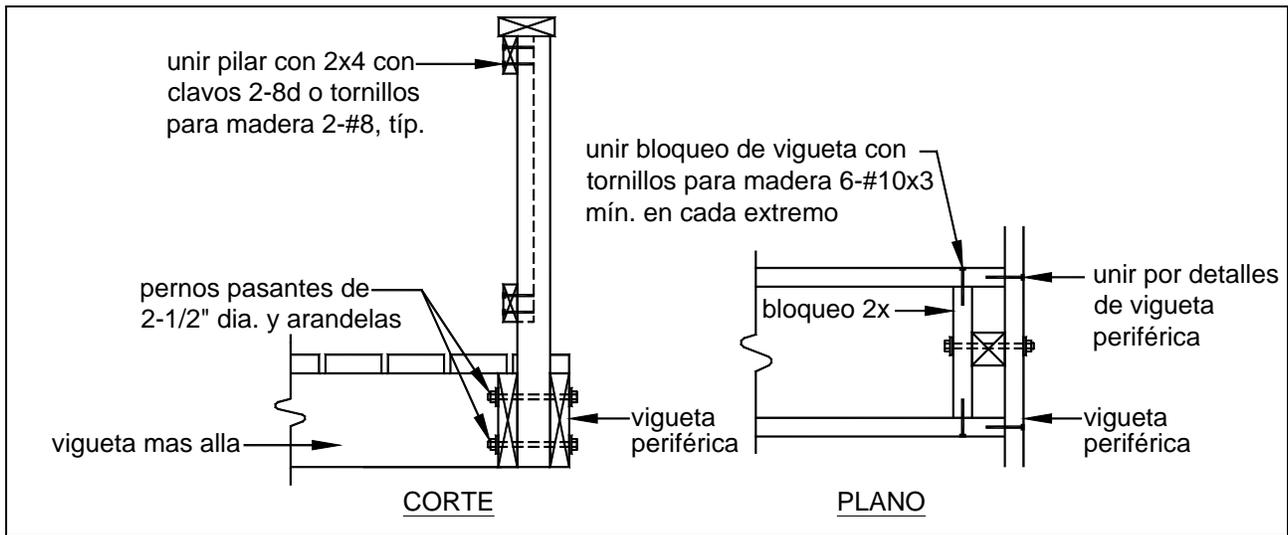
DETALLE DE UNIÓN DEL PILAR DE LA BARANDA A LA VIGUETA PERIFÉRICA, OPCIÓN 1
